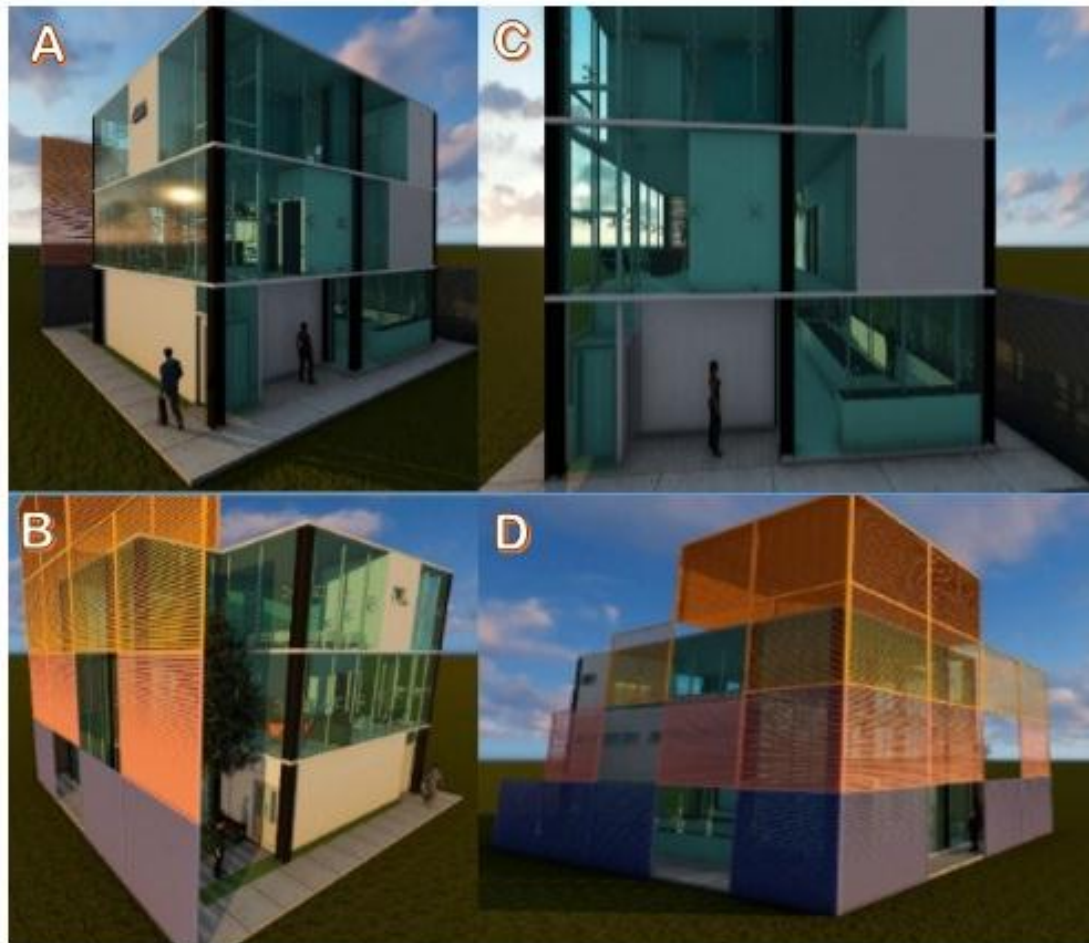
Projeto de reconstrução do LPU - URCA: A) Acesso a porta da fachada principal. B) Fachada posterior a fachada principal com acesso ao espaço de vivência. C) Fachada principal. D) Fachada lateral posterior a fachada principal com acesso ao espaço de vivência. Fonte: Arquivo LPU – URCA.
